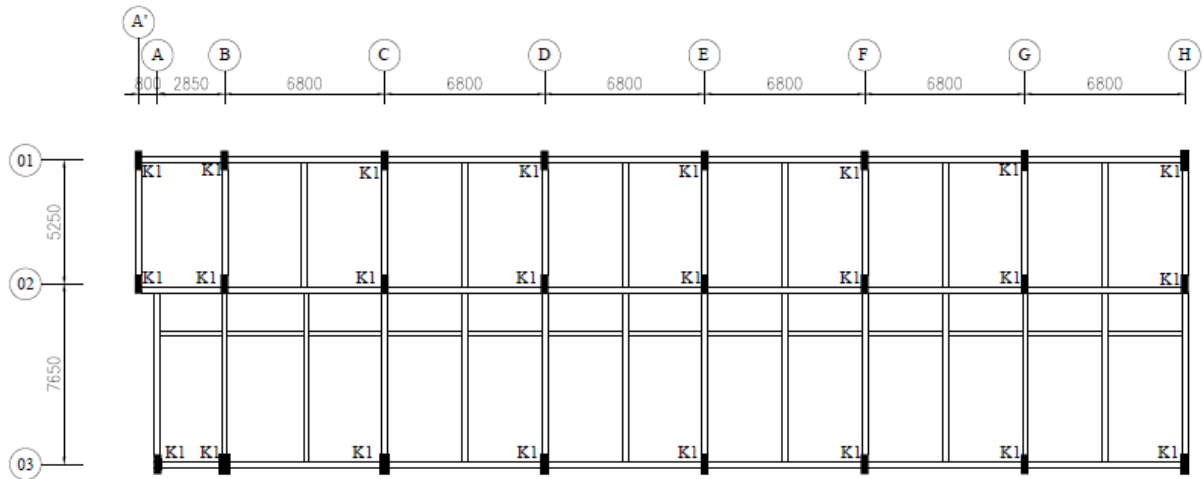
6 Denah Balok Hotel Neo Condotel Kota Batu.
